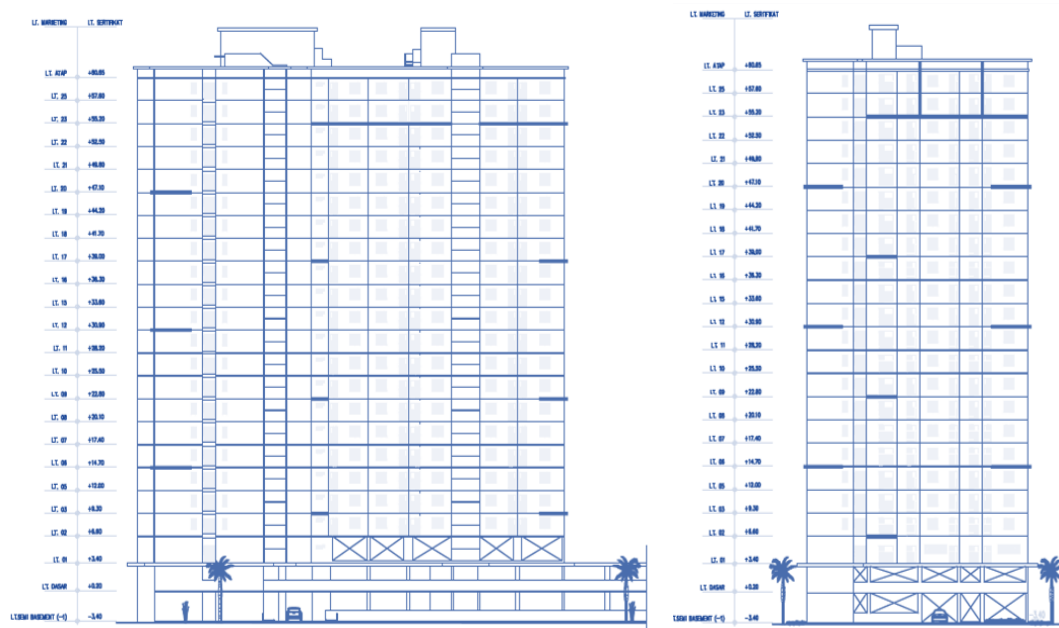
Denah Bangunan Apartemen Bassura City
